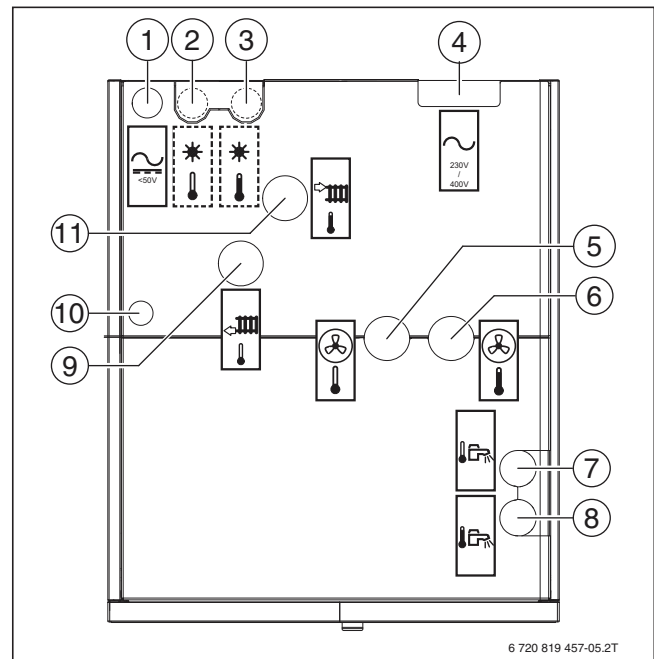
Rohranschlüsse IDU-8/14 iT/iTS (Draufsicht)
